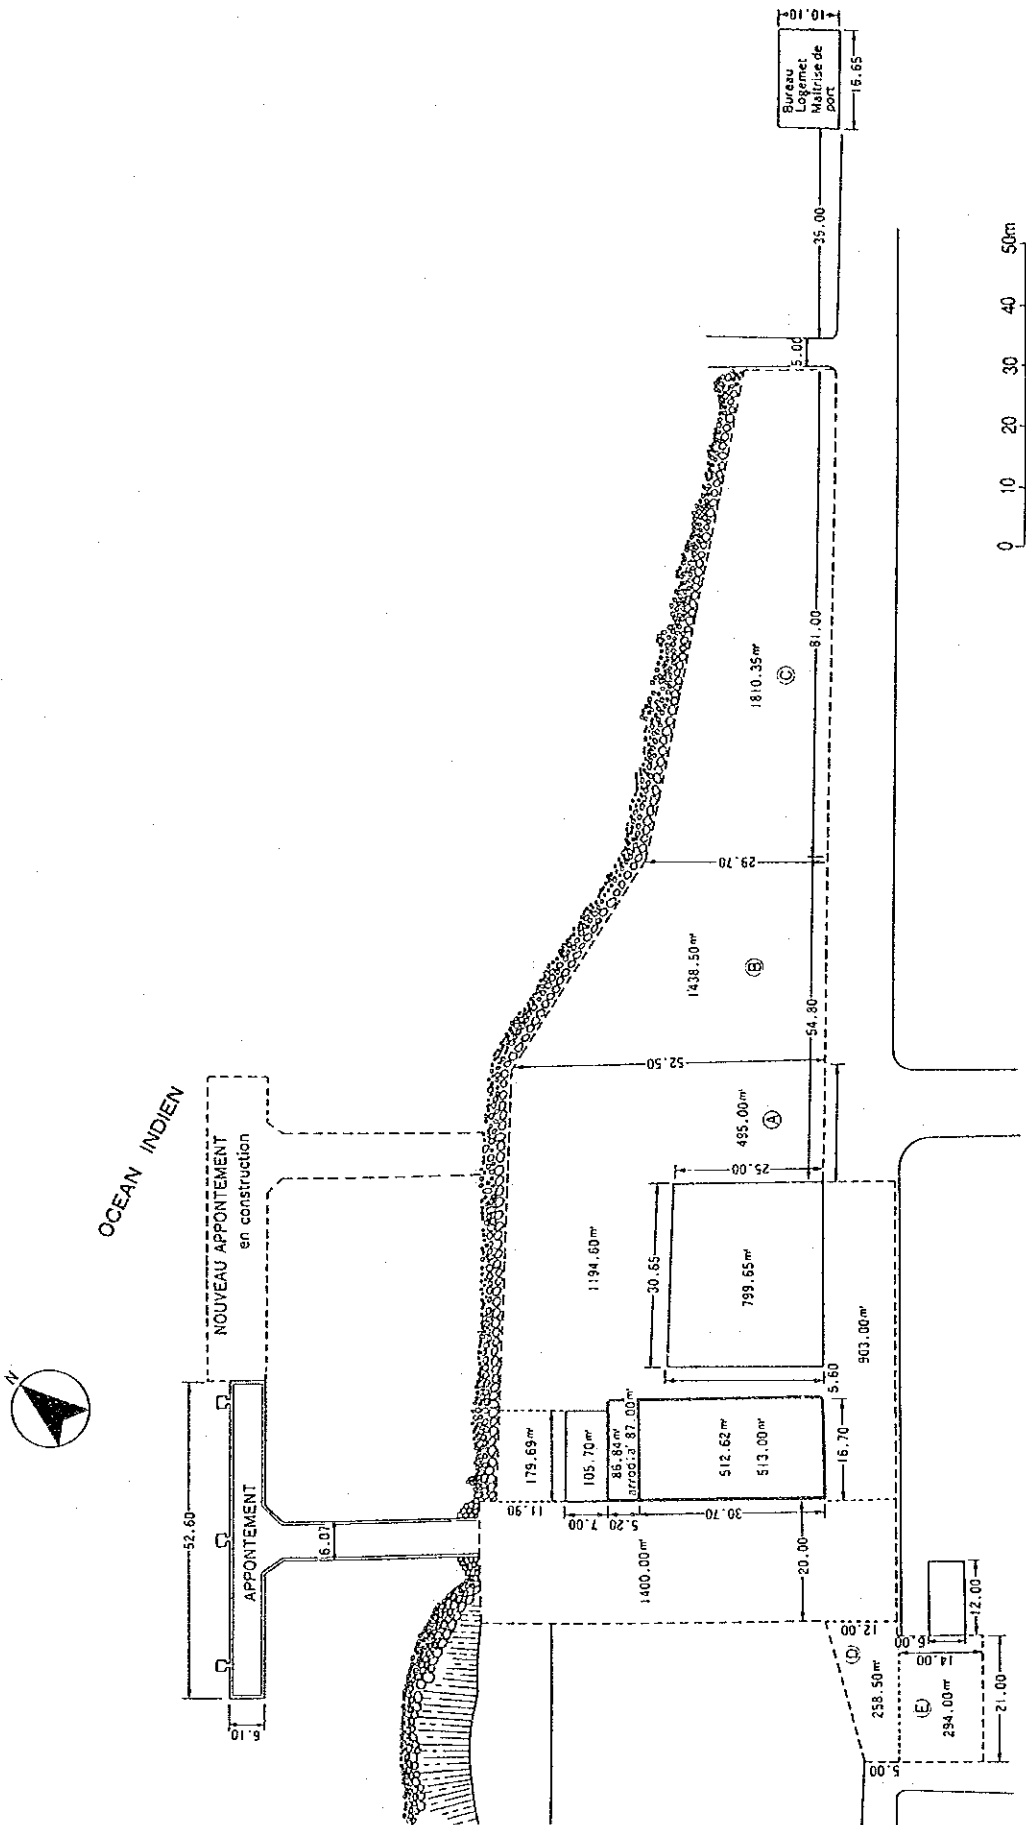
Plan d'implantation du Port de VOHEMAR
